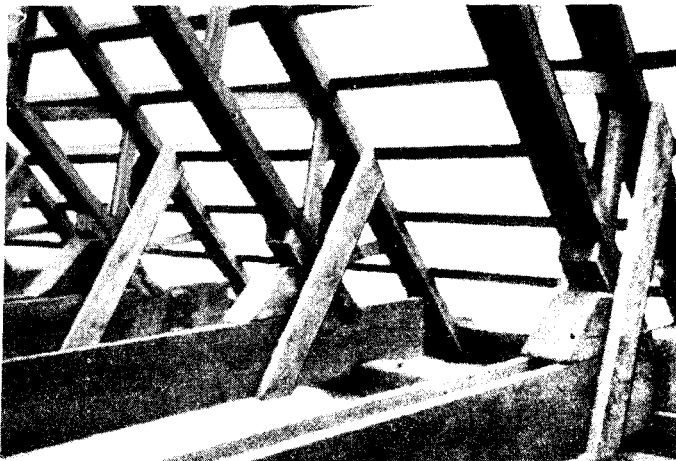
Tragwerk mit Sparren der Dreieck-Streben-Bauart
